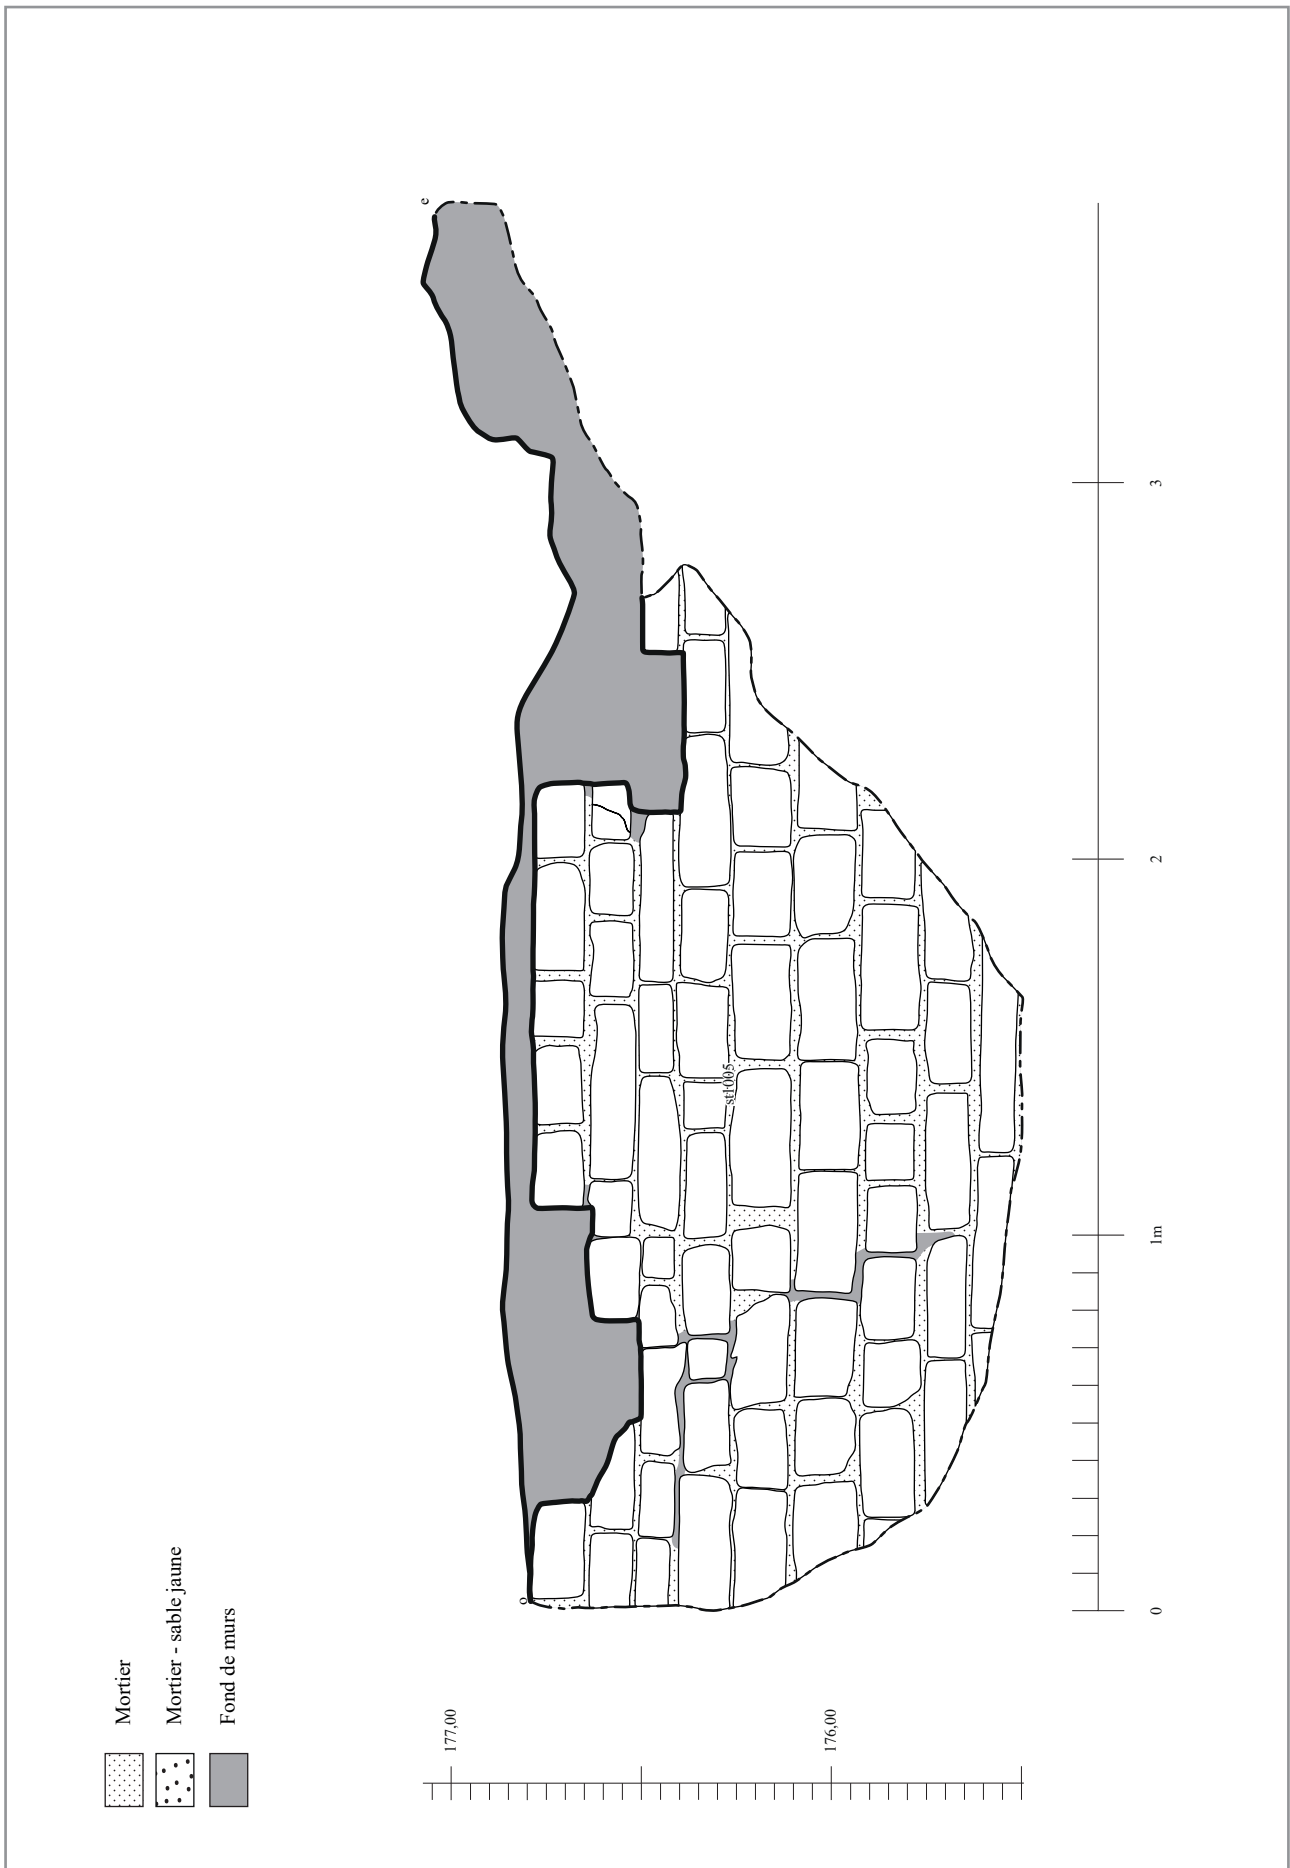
Parement sud du mur 1005 (échelle : 1/20 ; DAO : N. Lenôtre).
